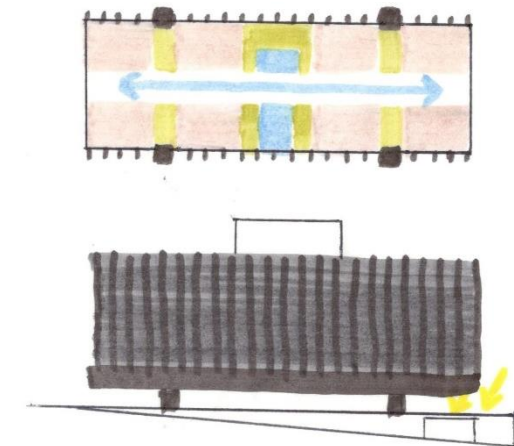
IPE. Há horizontalidade tanto em planta quanto em elevação. A estrutura define o partido do edifício. Destaque para iluminação zenital para o subsolo.
